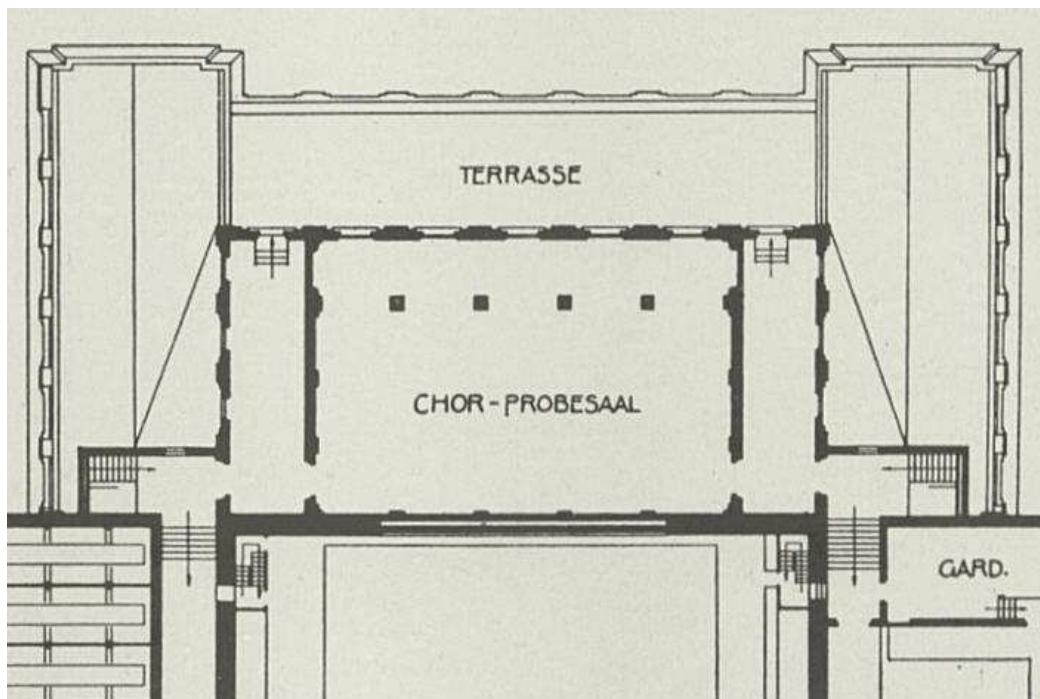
13. Ausschnitt Grundriss 3.Rang
